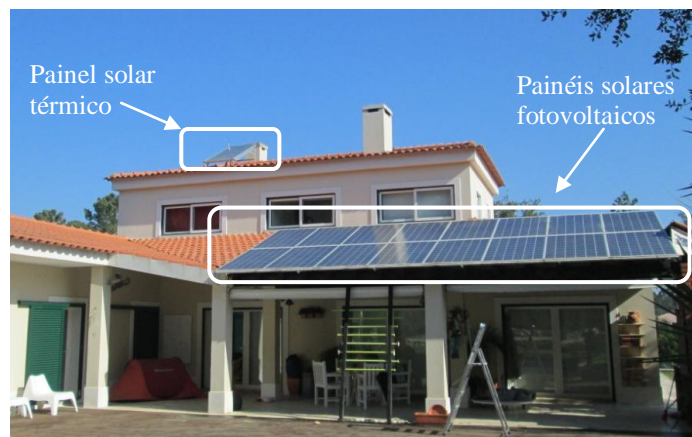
Vista das fachadas interiores do edifício de habitação e dos painéis solares.
